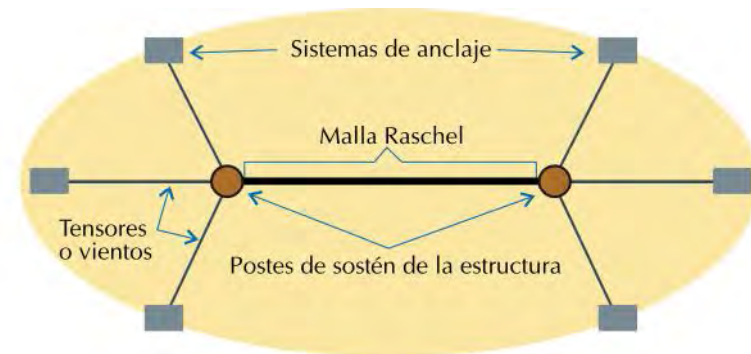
Vista en planta de la ubicación de los sistemas de anclaje, con respecto a los postes que sostienen la estructura.
